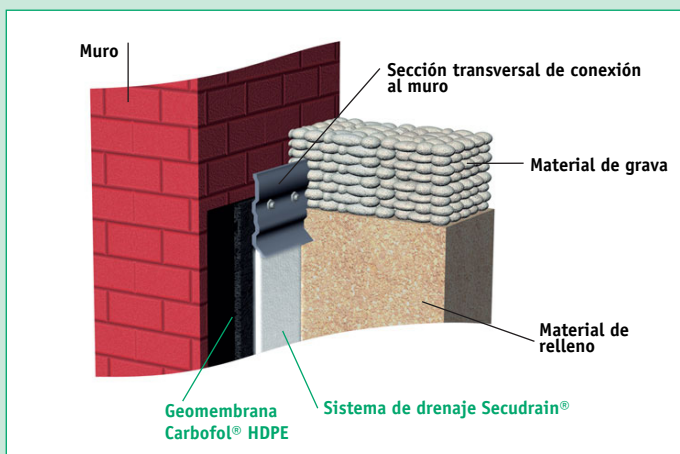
Drenaje de la estructura (detalle de la conexión al muro).
